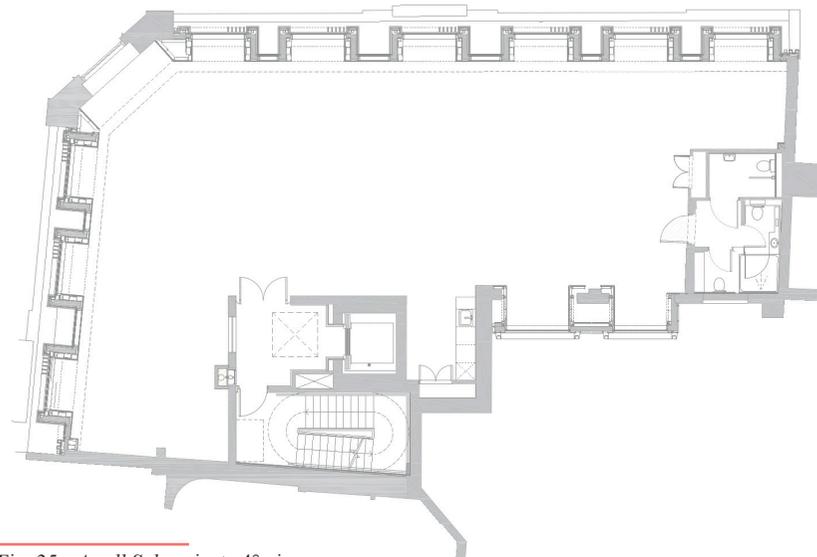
Axtell Soho*, pianta 4° piano.
